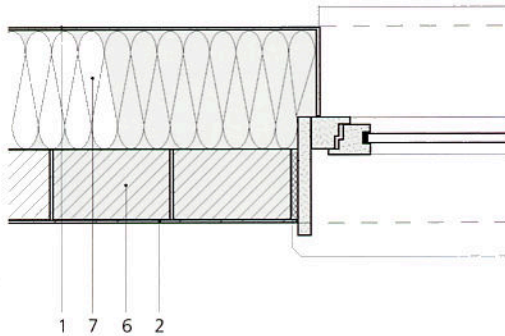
Détail de construction : coupe verticale d'un détail de fenêtre
